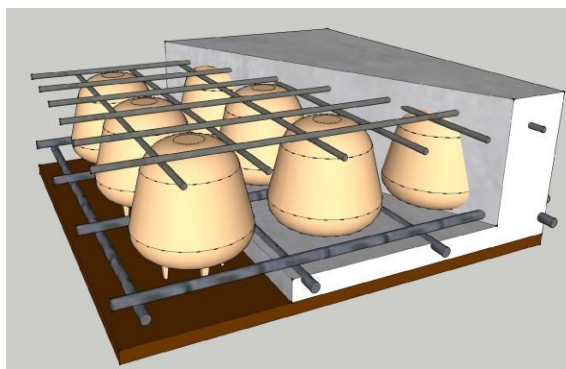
Фрагмент конструкции перекрытия с заменой части тяжёлого бетона вкладышами из пластмассы
